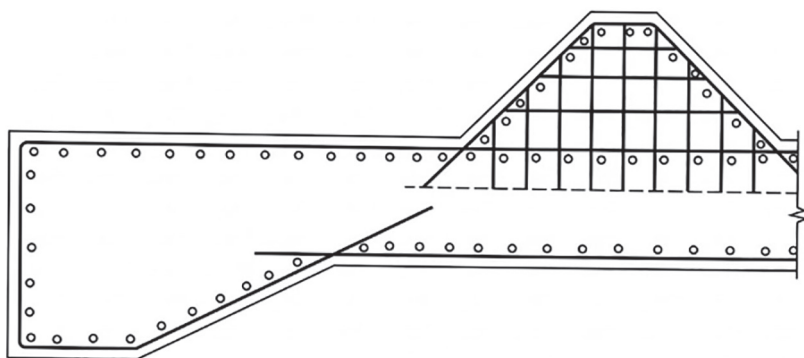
Esquema de armado de la losa de disipación con dados.
